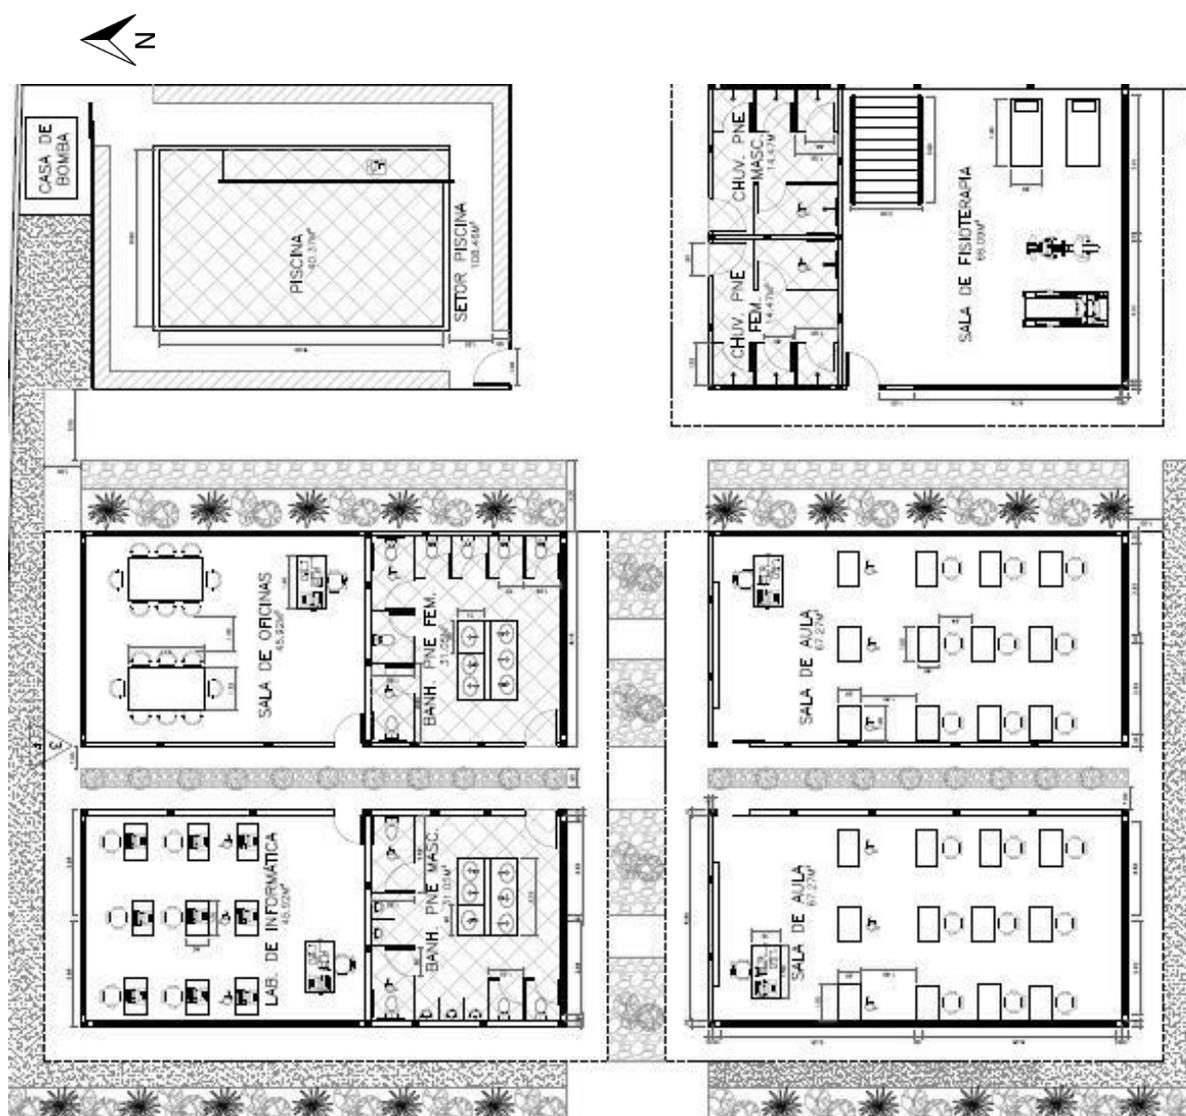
Planta baixa do setor educacional – Prancha 3/5.
